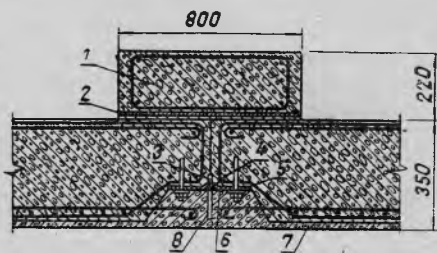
Соединительная муфта железобетонного трубопровода:
